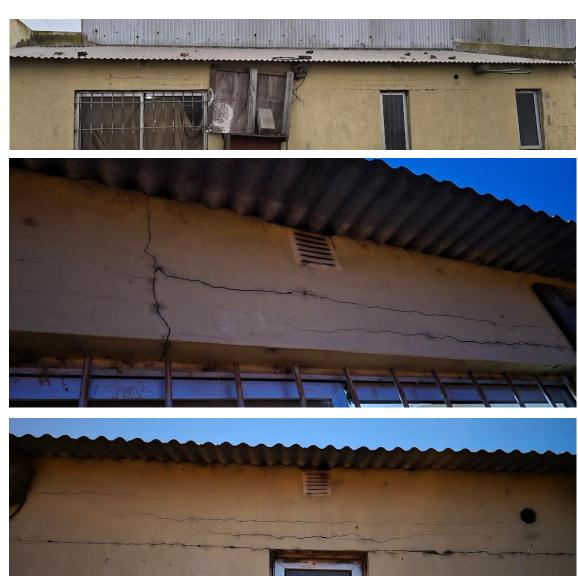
y 9 – Encuentro entre chapa de cubierta y muros laterales
